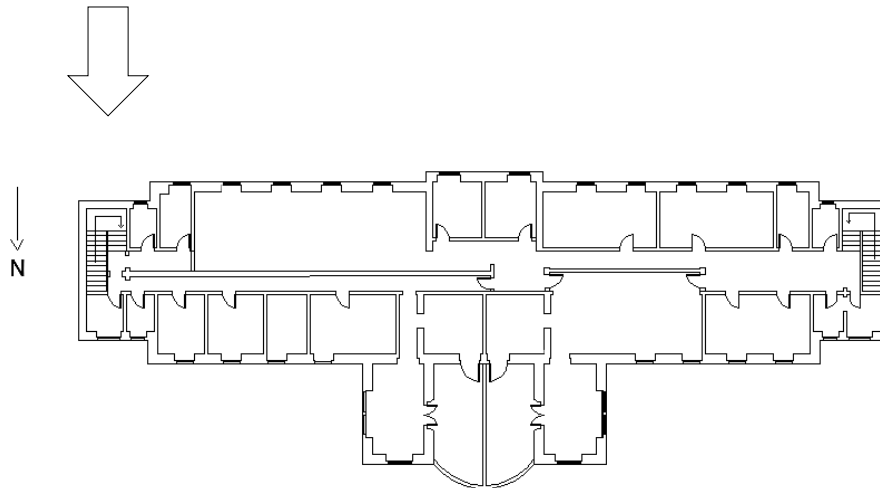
Desenho do existente Planta piso 1 (assinalando o problema encontrado no corredor de reduzida dimensão)
